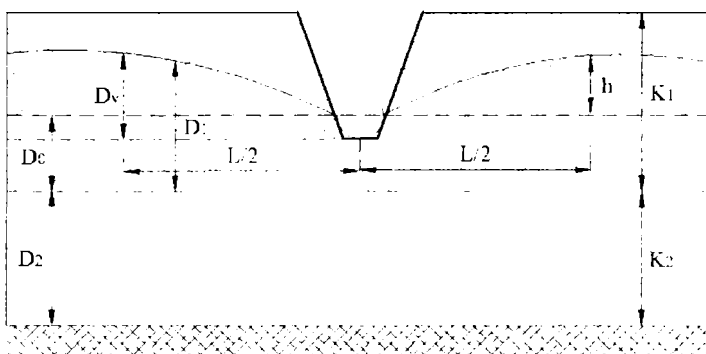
Elementele de calcul ale drenajului când planul de separare a solurilor este sub dren
